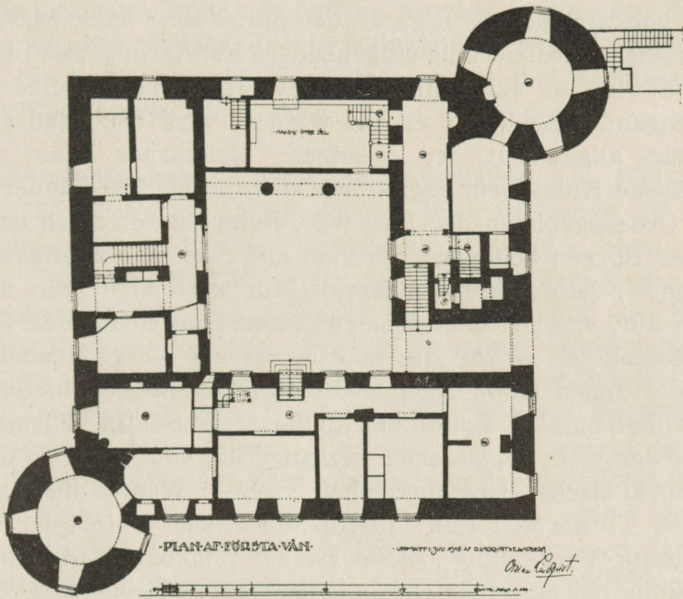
Torup, Grundriss des ersten Stockwerks. Nach H a h r.
